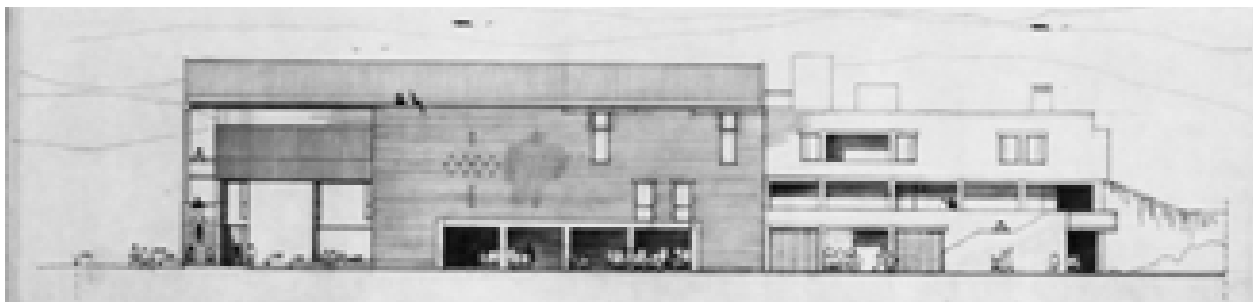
Prospetto Ovest, stato attuale –09/12/1997 (AABS-1996.990)
